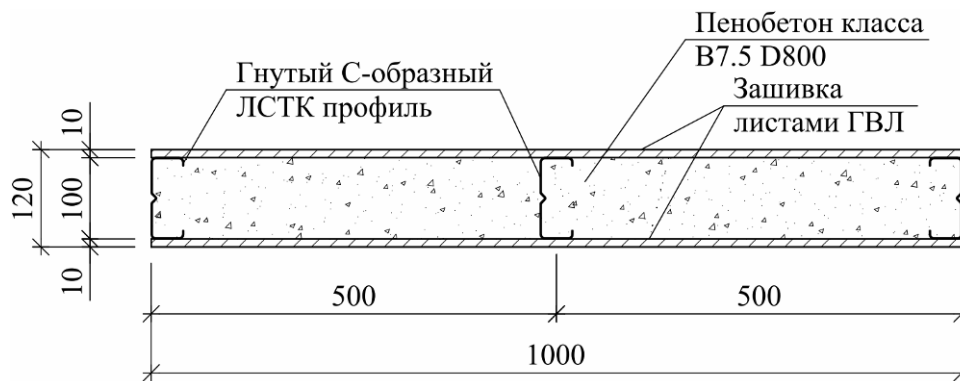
Конструкции фрагмента плиты перекрытия
